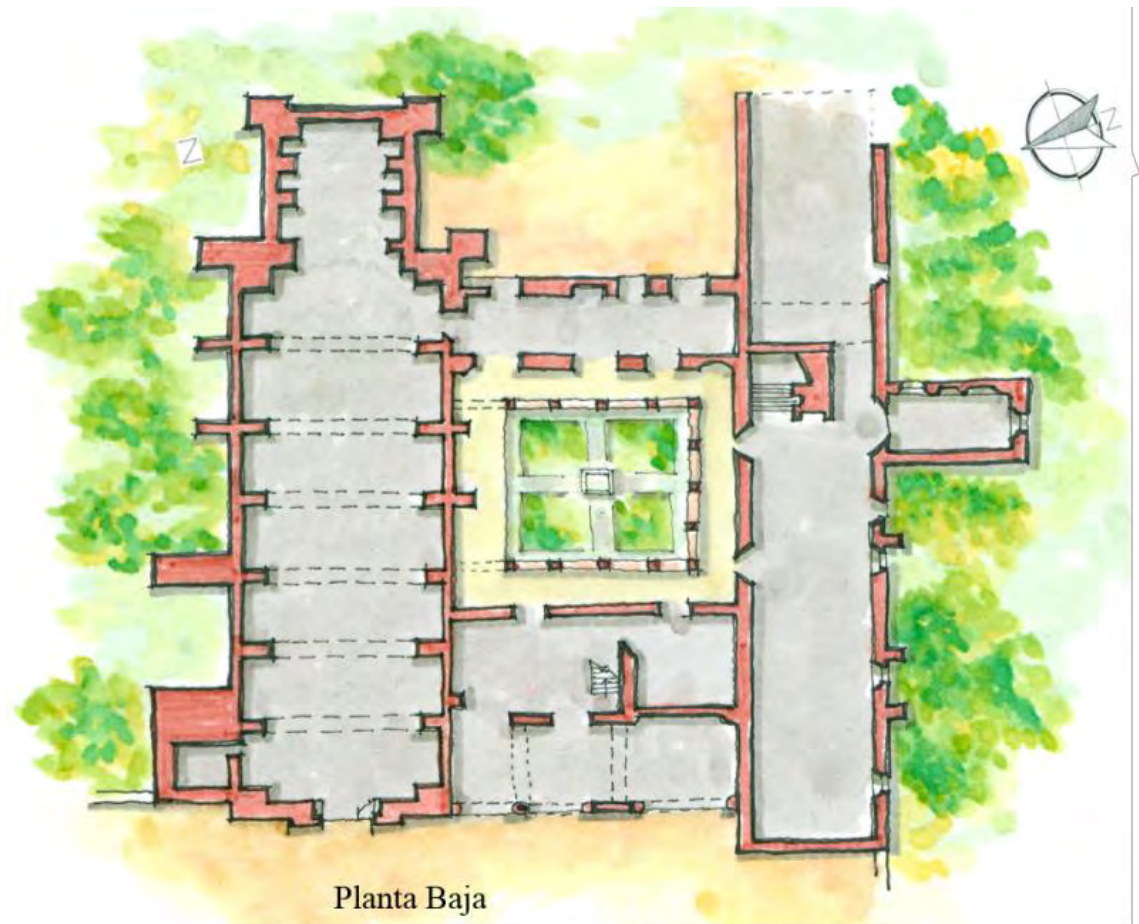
Zacualpan de Amilpas, Mor. Ex convento La Inmaculada Concepción. Planta arquitectónica.
